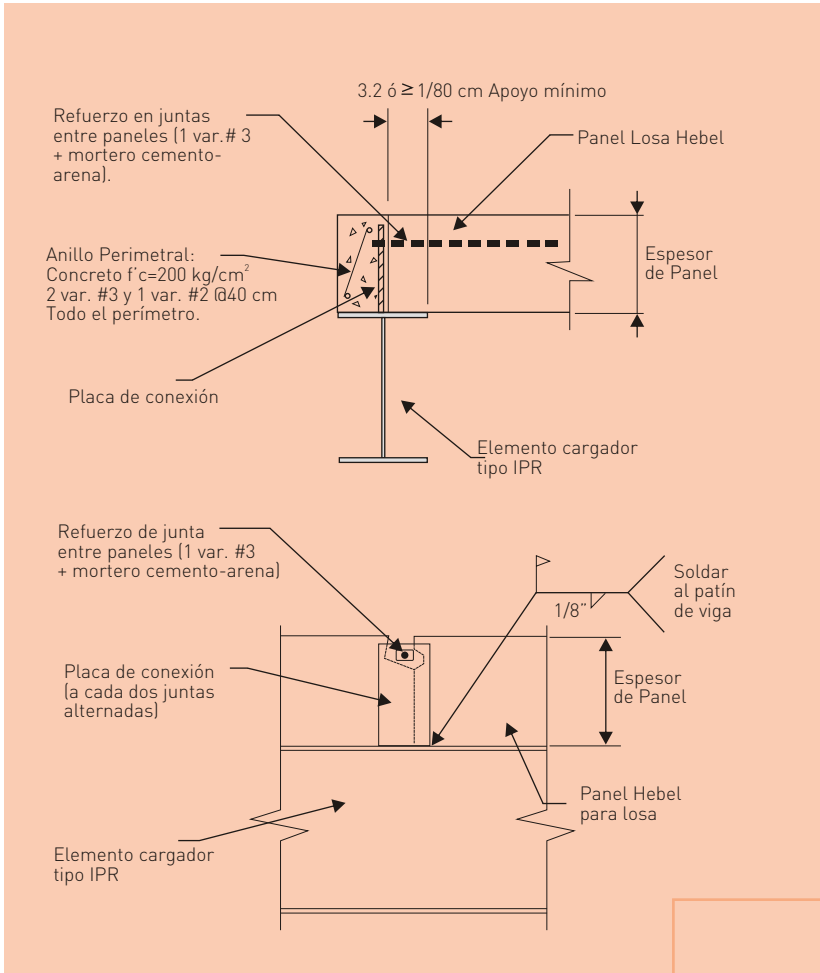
Detalle de anillo perimetral en elemento de acero.
